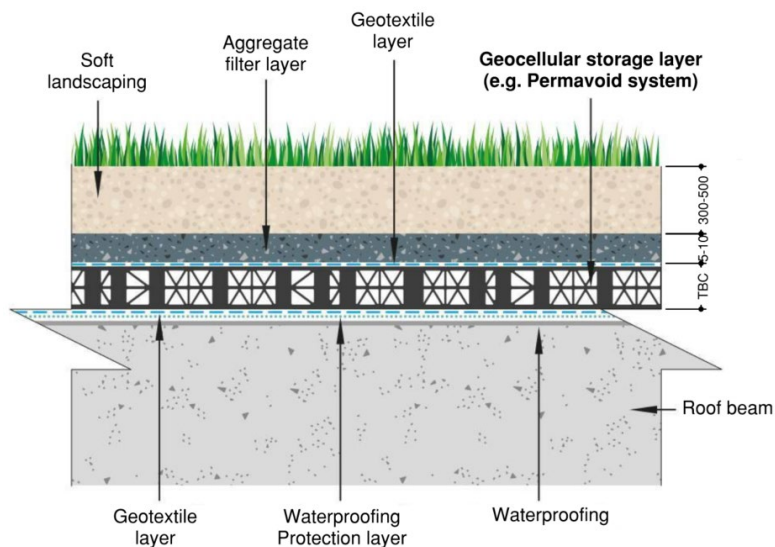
Sistema di impermeabilizzazione proposto per l'area del tetto
